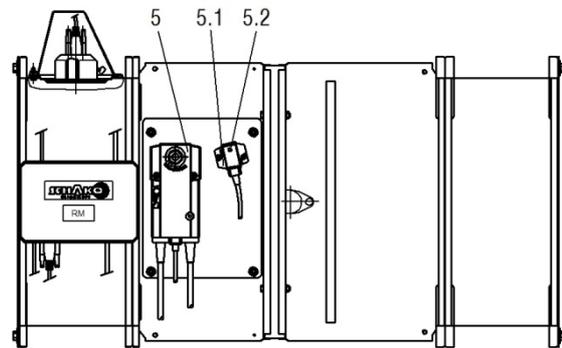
Seitenansicht BKA-Ü (Federrücklaufantrieb)
